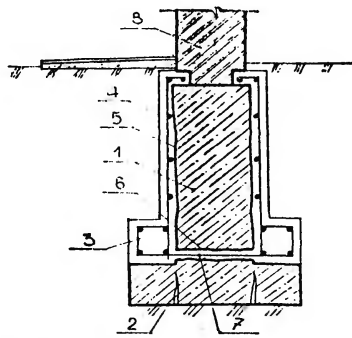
Устройство продольных балок на ступенях с железобетонной рубашкой
